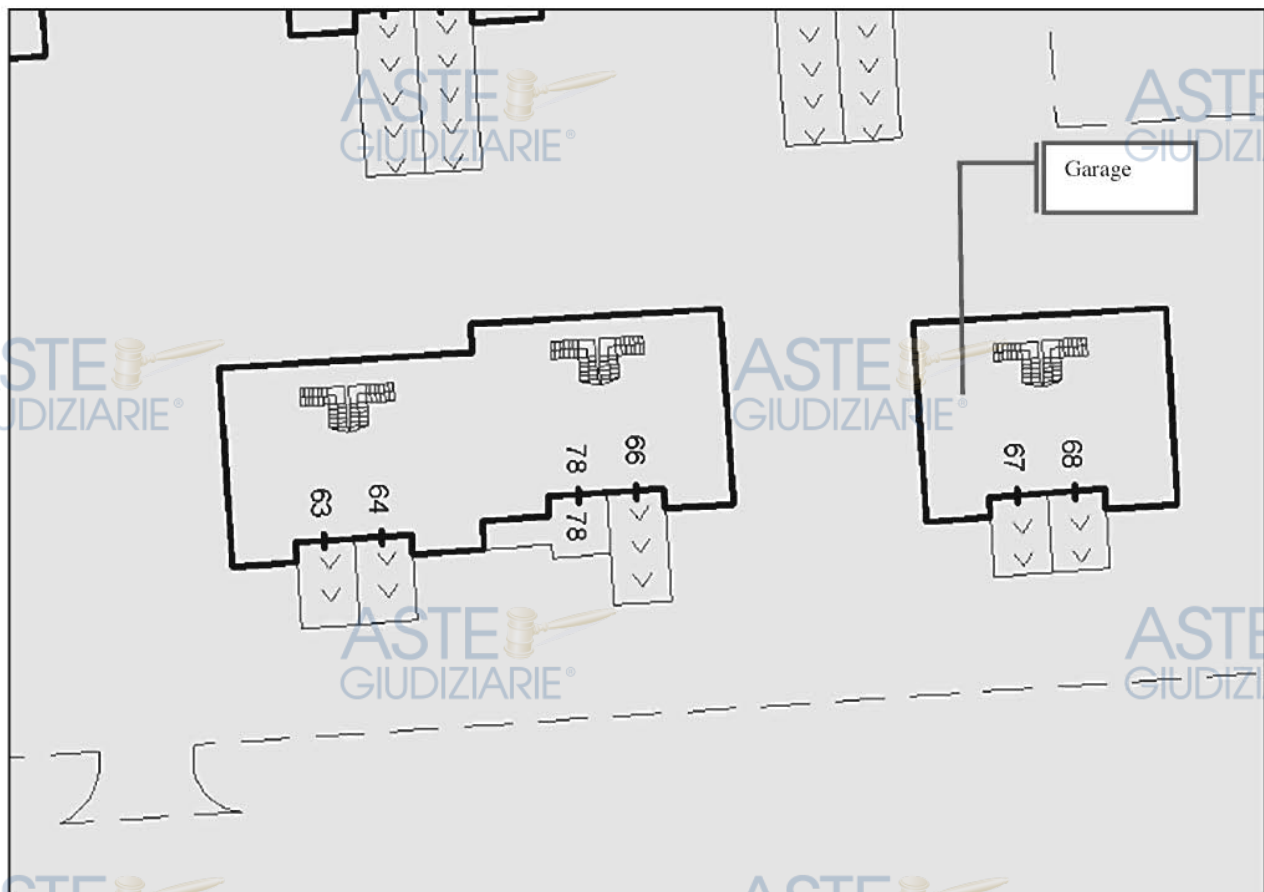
Visualizzazione dell'elaborato planimetrico del piano primo sottostrada- individuazione del sub. 67
